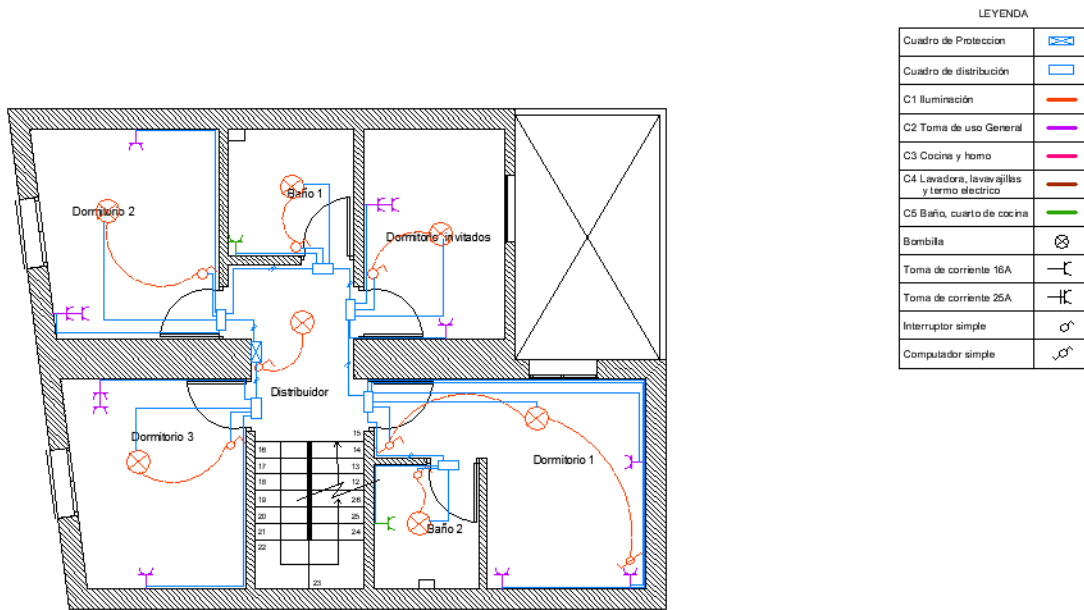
Croquis de sistema eléctrico planta uno. Fuente propia
